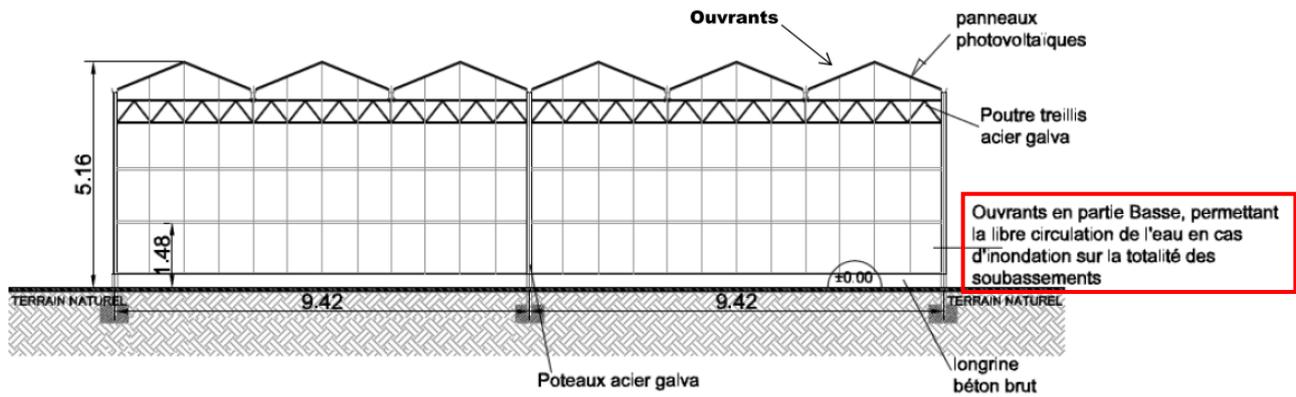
Coupe type serre multi-chapelles, côté pignon
